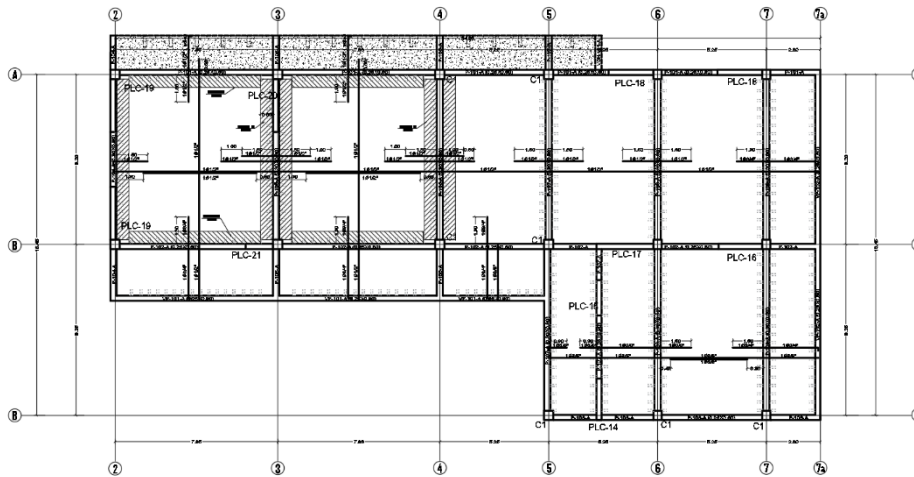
Plano de encofrado de Techo de Primer y Segundo nivel Bloque A, Fuente: Elaboración Propia
